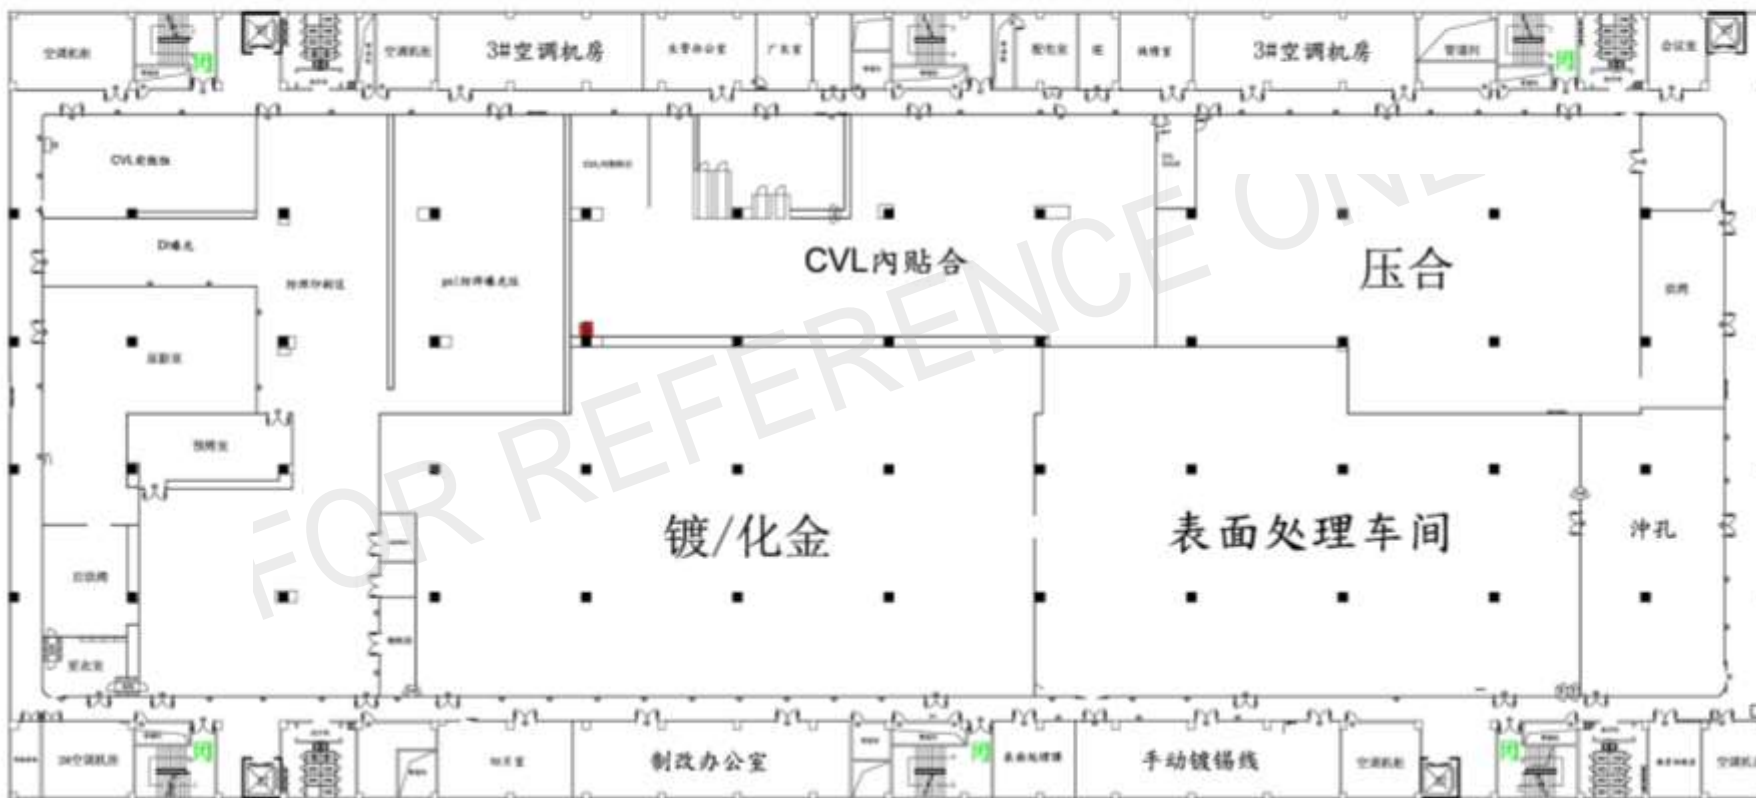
鹏鼎公司 A1 栋厂房三层车间平面布置图
